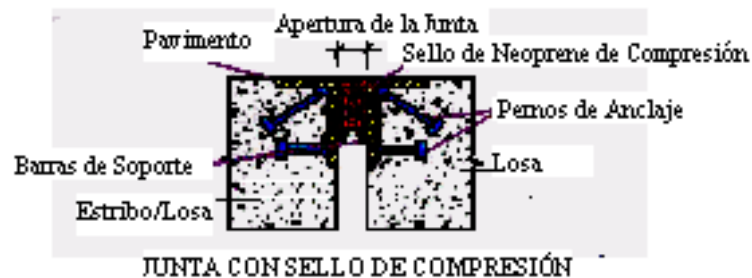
Componentes de una Junta Rellena con Sello de Compresión.
